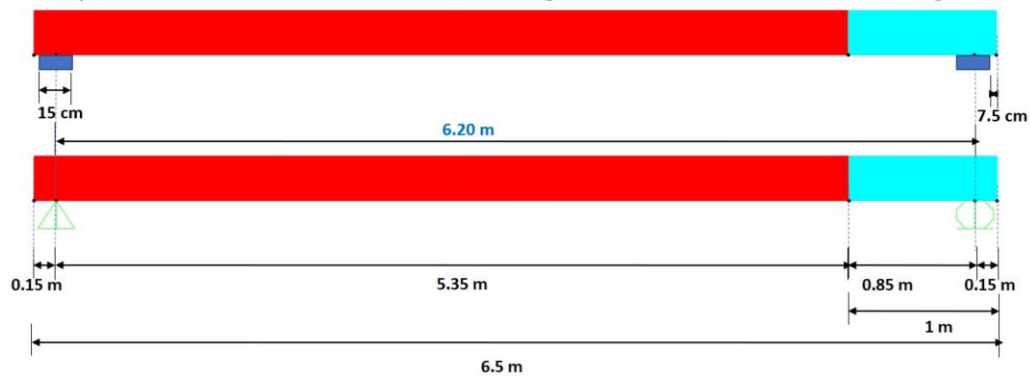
Geometría y sección longitudinal de una viga aislada
